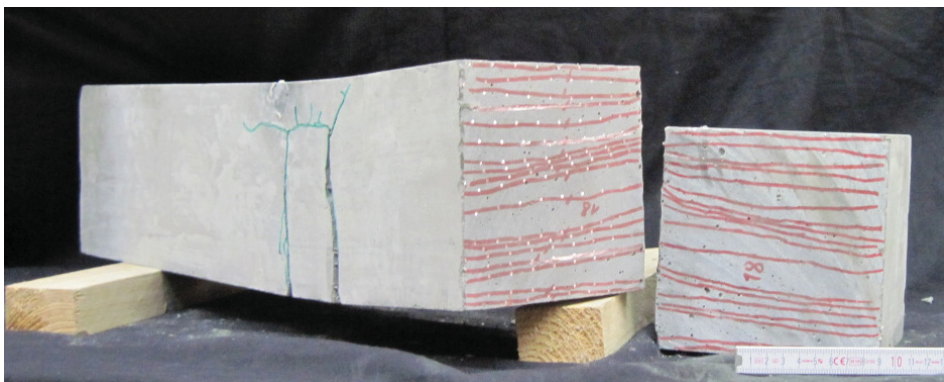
Sägeschnitt des Balkens MB3-2,5-4-h
